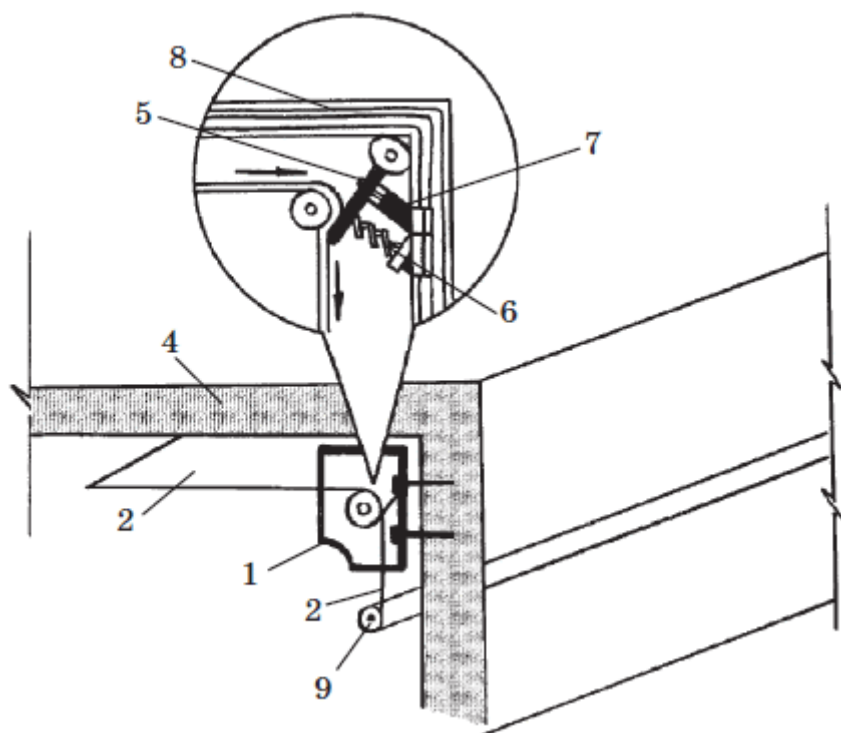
Багетное крепление натяжного потолка: 1—корпус; 2 – полотно (пленка или пластик); 3 – валик; 4 – бетонный потолок; 5 – рычаг фиксатора; 6 – пружина рычага фиксатора; 7 – выключатель фиксатора; 8 – ось рычага фиксатора; 9 – валик для выравнивания пленки во время натяжения
